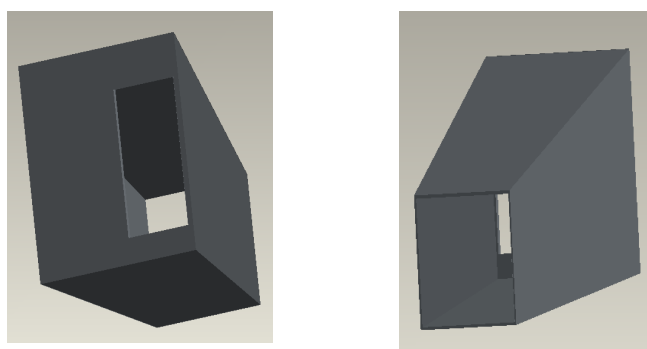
Umístění oblouku za ventilátorem: vlevo – špatně, vpravo – správně [5]
